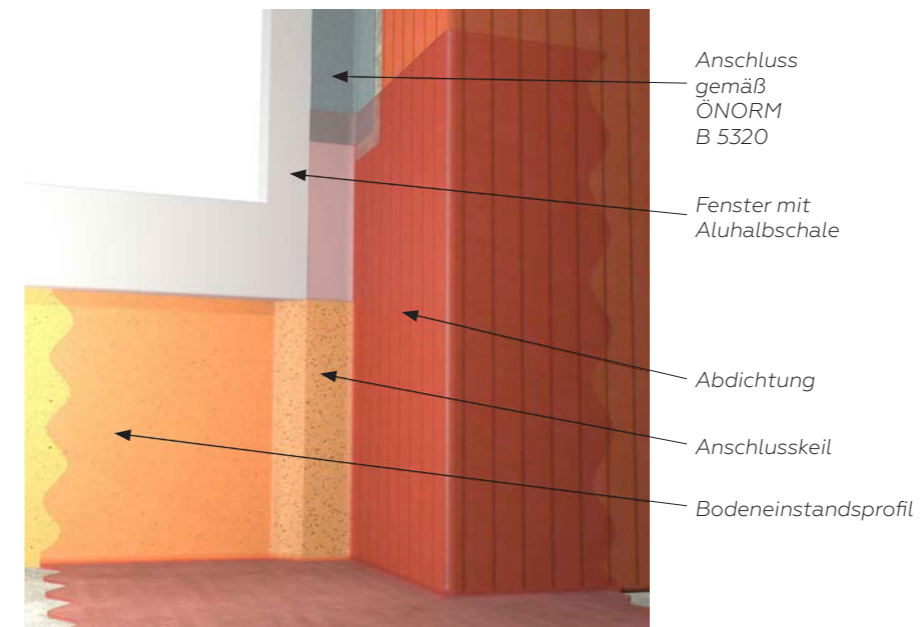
Prinzipskizze Fenster mit Anschlusskeil und Abdichtung
